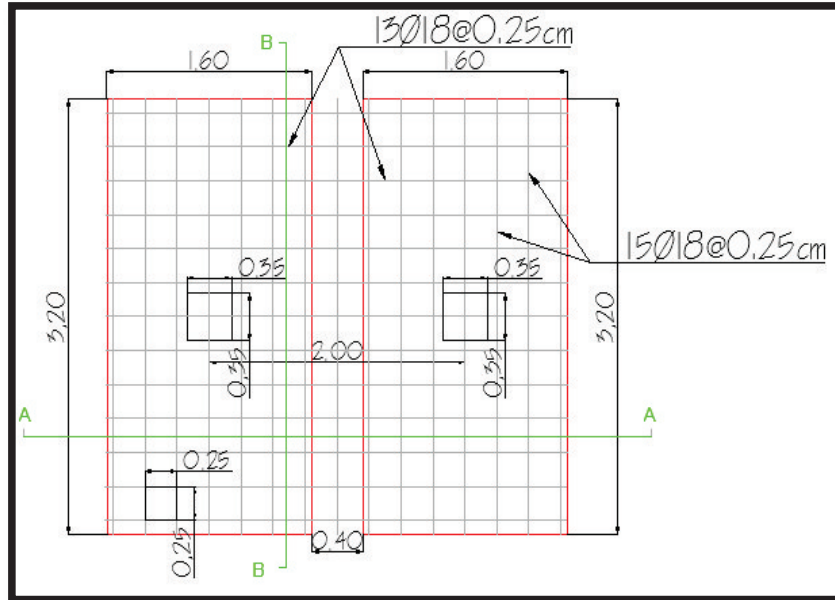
Diseño a flexión, armado de varillas en la dirección x y en planta
